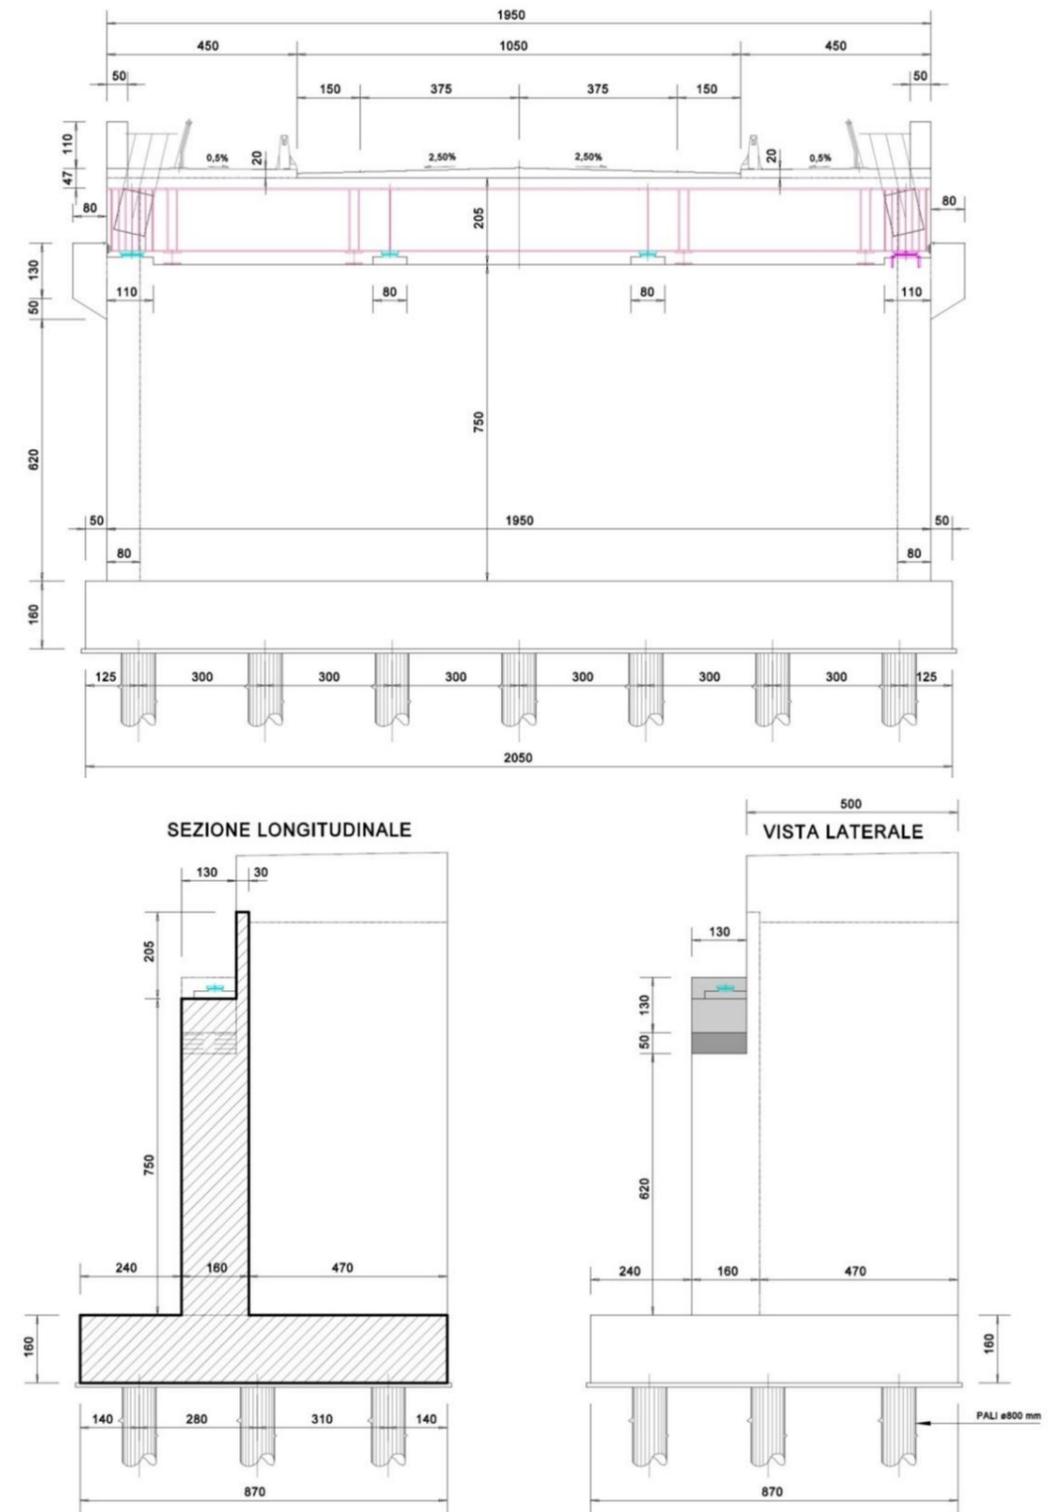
Ponte sul Fiume Oglio – Carpenteria spalla tipo
